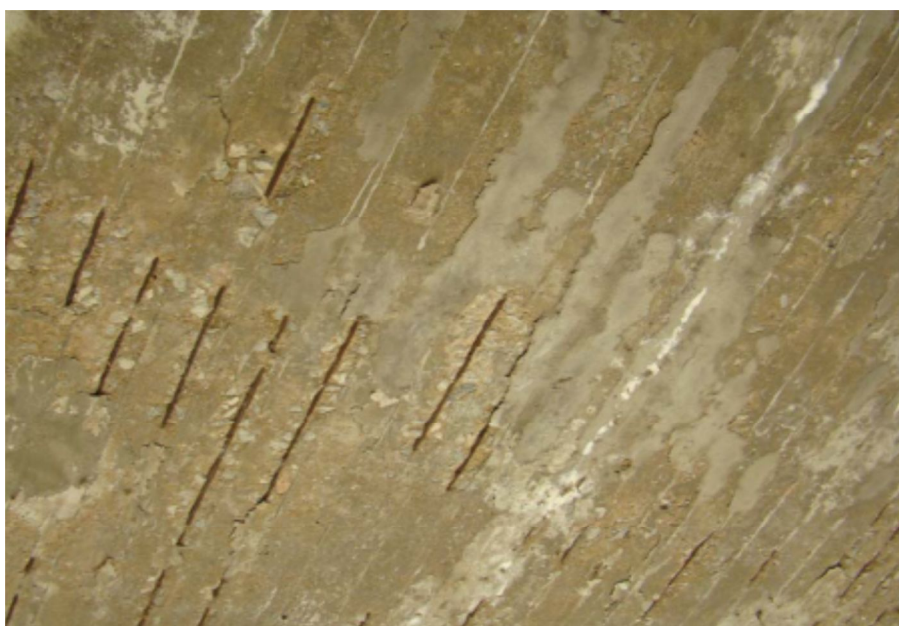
Detalhe fissuras na primeira transversina entre pilar P1 e P2
